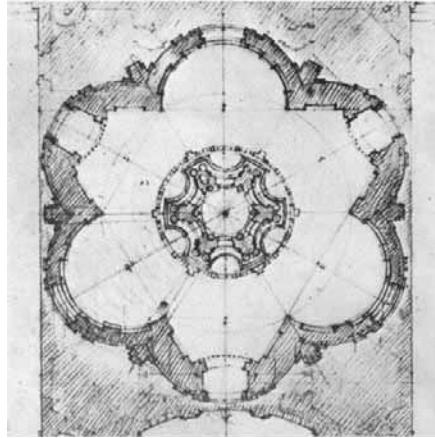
F. Borromini, Chiesa di S. Ivo alla Sapienza. Nello studio planimetrico della chiesa emerge l'interesse dell'architetto verso la geometria della pianta centrale, in particolare verso la matrice esagonale ottenuta dall'intersezione di due triangoli, di cui uno lobato.
